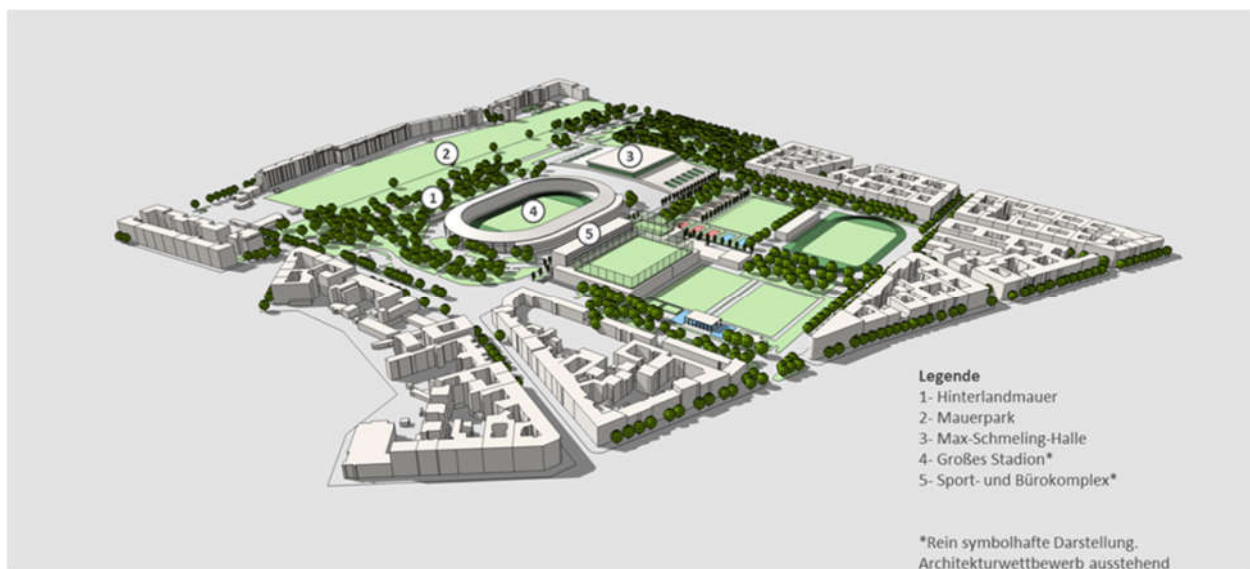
Lageplankonzeption Variante 3 – Übersicht
